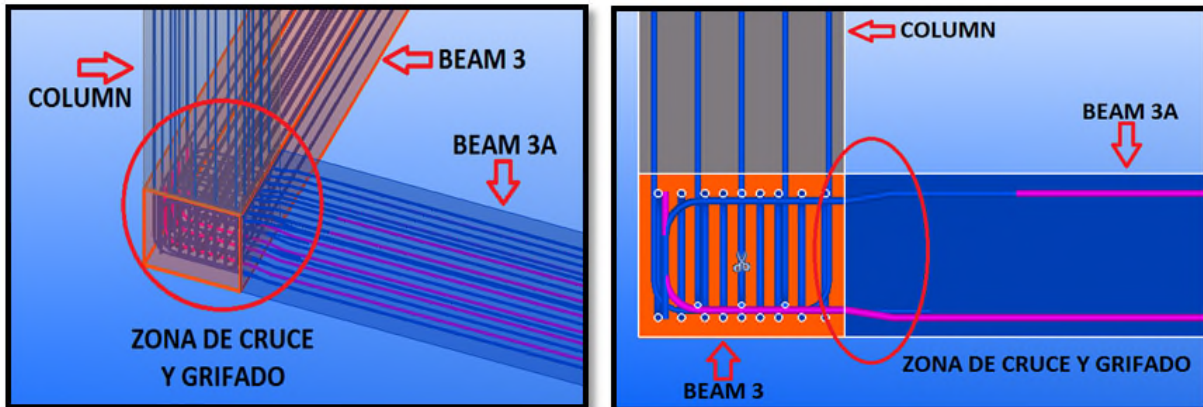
Disposición de armadura en encuentro viga de cimentación/arranque de pilar
